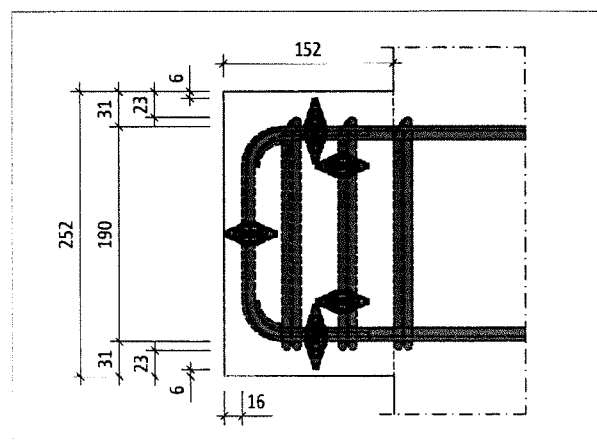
Schöck Tronsole® Typ Z: Grundriss einer Auflagerkonsole mit eingebautem Tragelement
